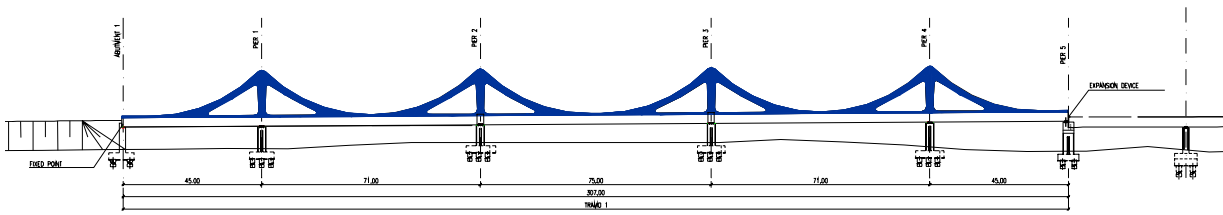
Alzado general del puente de Llinars (tramo metálico).
